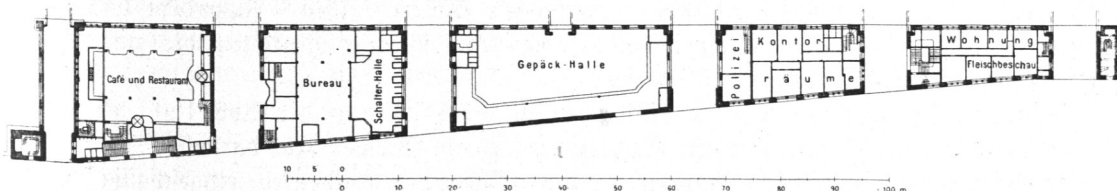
St.-Pauli-Landungsbrücken, Grundriß des Erdgeschosses.
